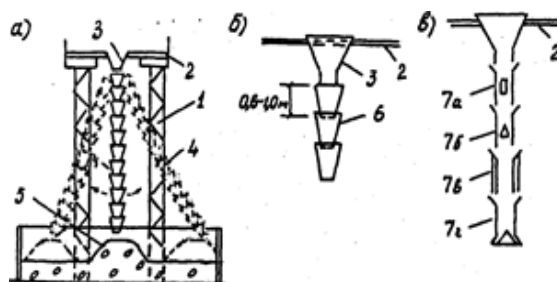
Схемы подачи бетонной смеси с высоких этажад: а) общая; б) схема хобота; в) схема виброхобота.
